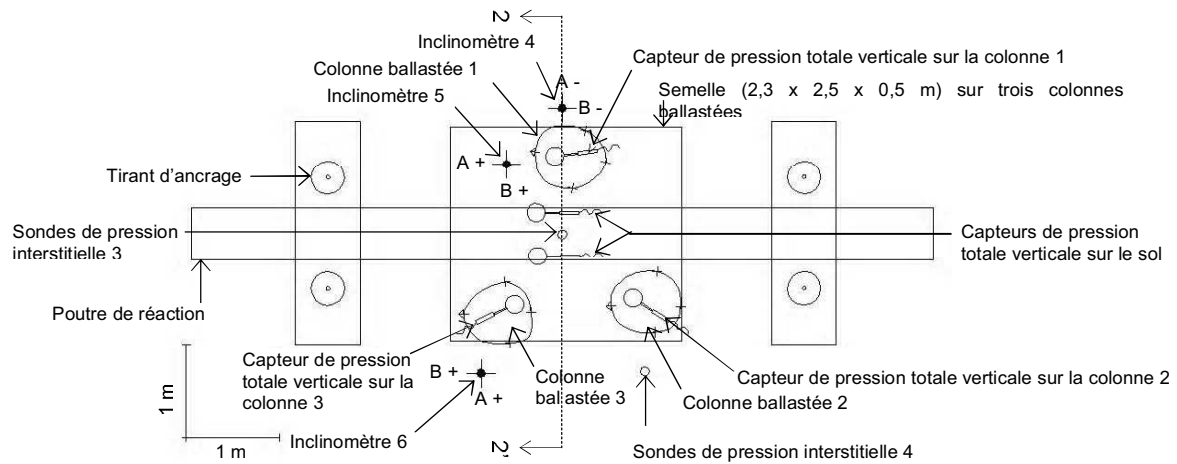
Vue en plan de la configuration de l'essai de chargement de la semelle (2,3 x 2,5 x 0,5 m) sur trois colonnes ballastées.
